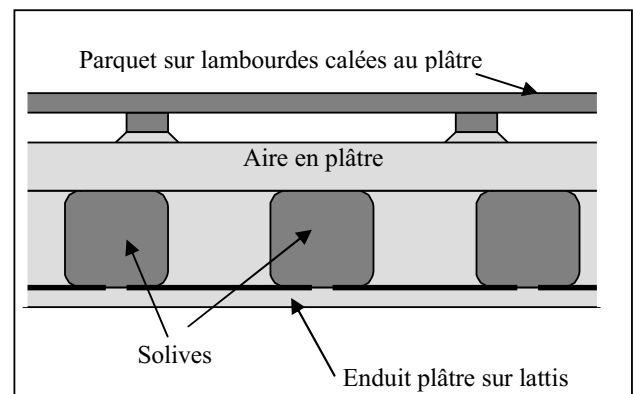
Coupe d'un plancher ancien du type « vide pour plein » avec aire en plâtre
